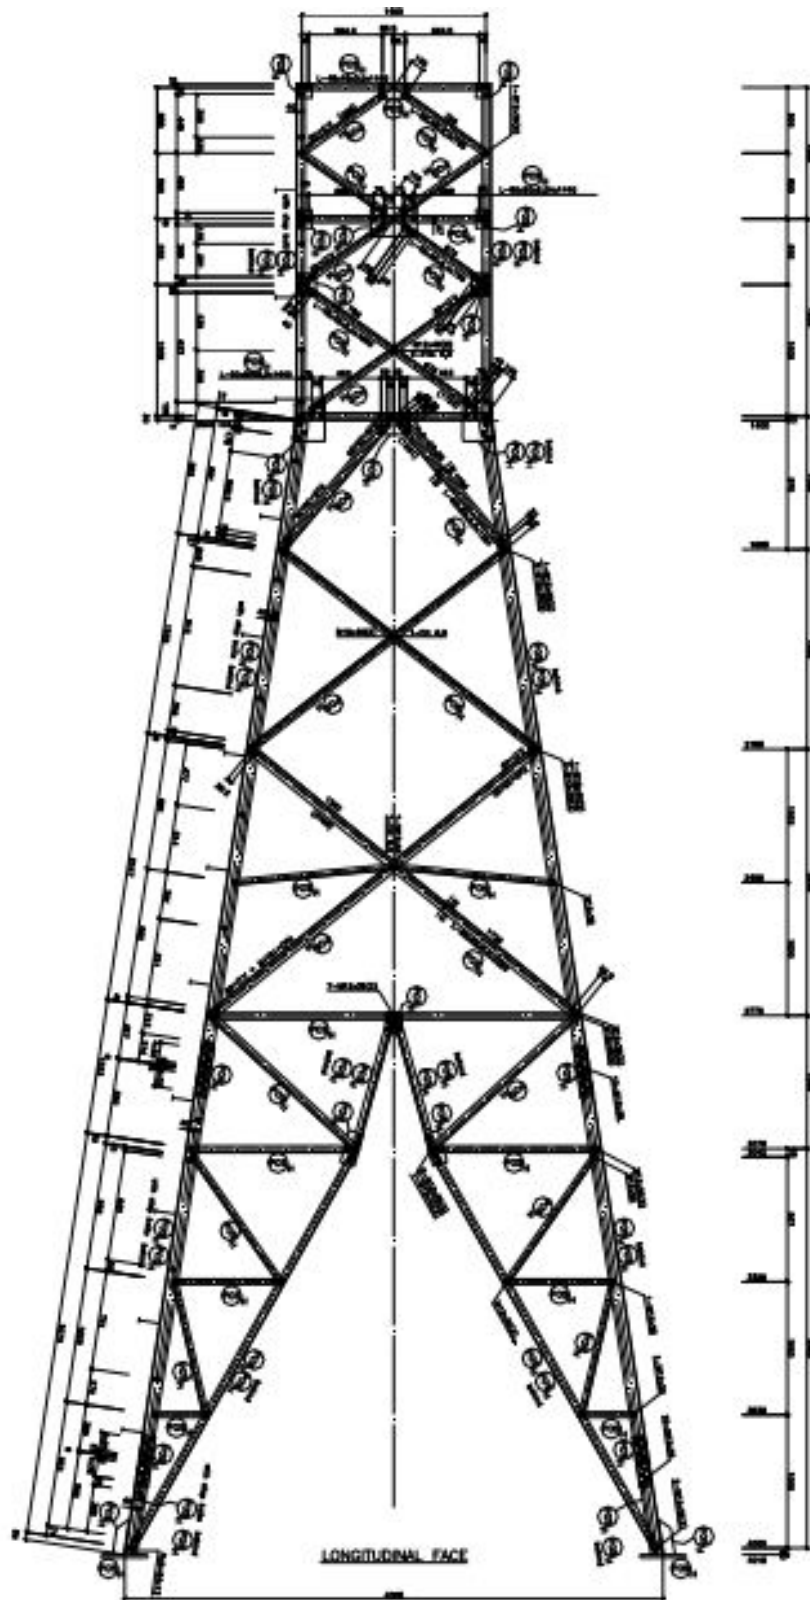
Estrutura "1"- detalhamento da face longitudinal.
